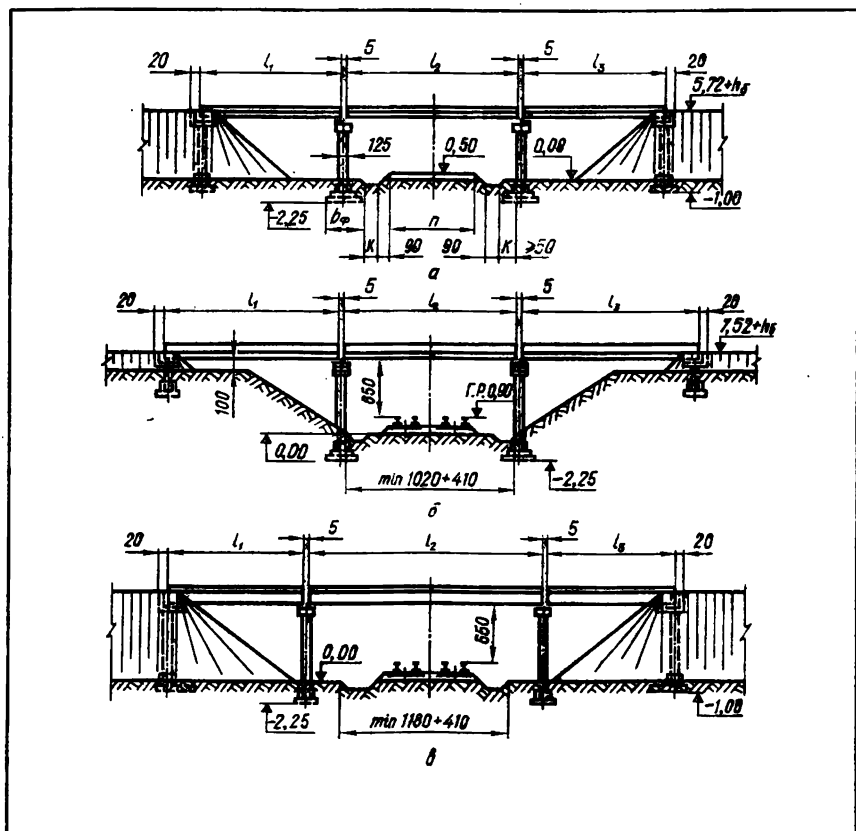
Схемы типовых путепроводов с разрезными пролетными строениями при пересечении:
